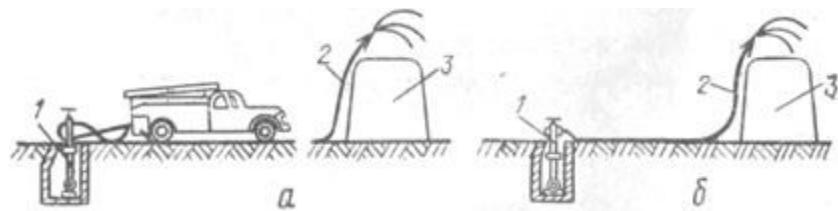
Схемы подачи воды на тушение пожара от водопровода:
